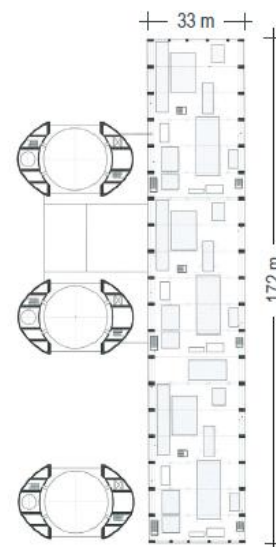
Planta de las instalaciones de las Tres Chimeneas. Fuente: Página web Front Litoral
